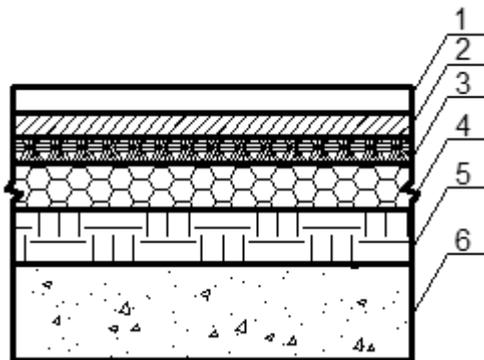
Конструкция перекрытия над неотапливаемым подвалом:
